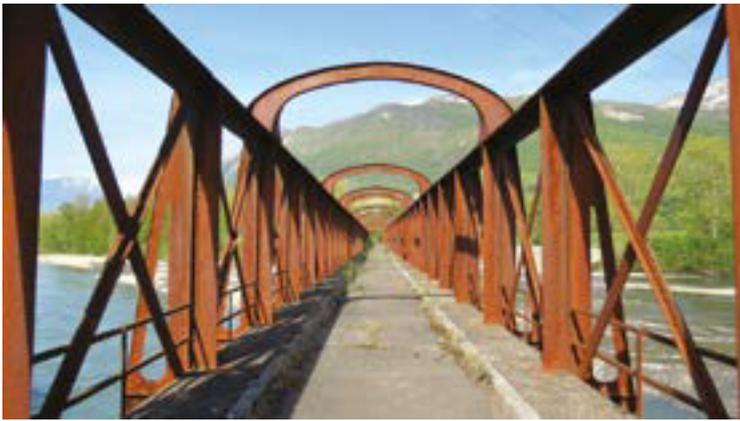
| Ponte a Cruet: vista della travata reticolare continua (ACN&P).
